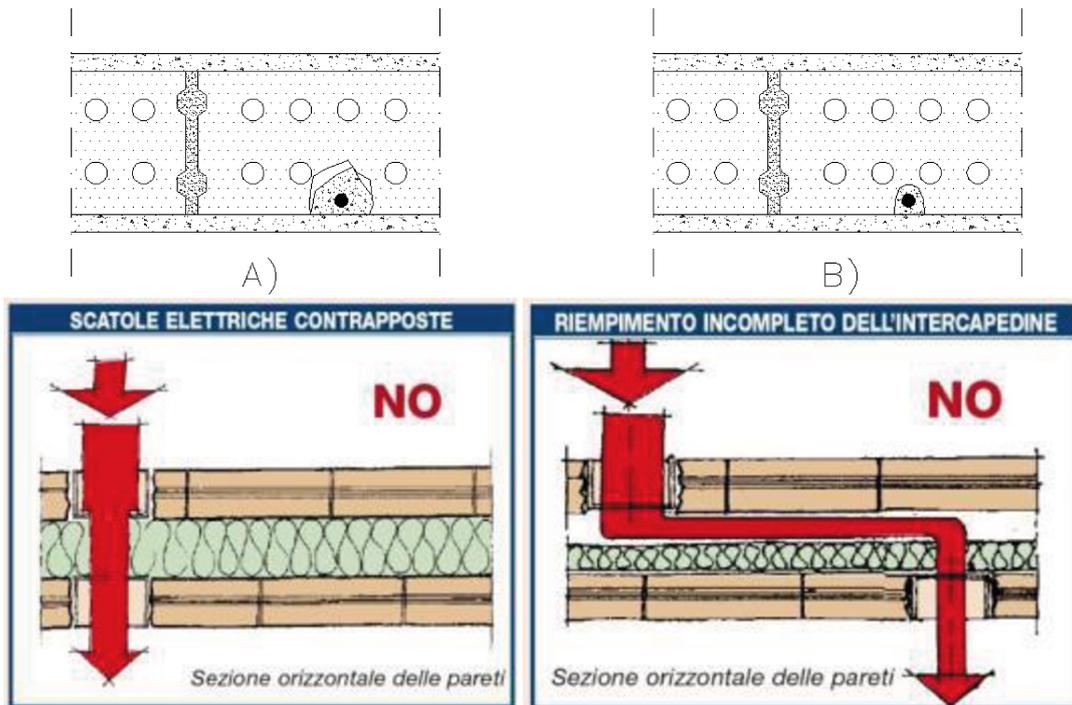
A) Traccia errata – B) Traccia corretta
